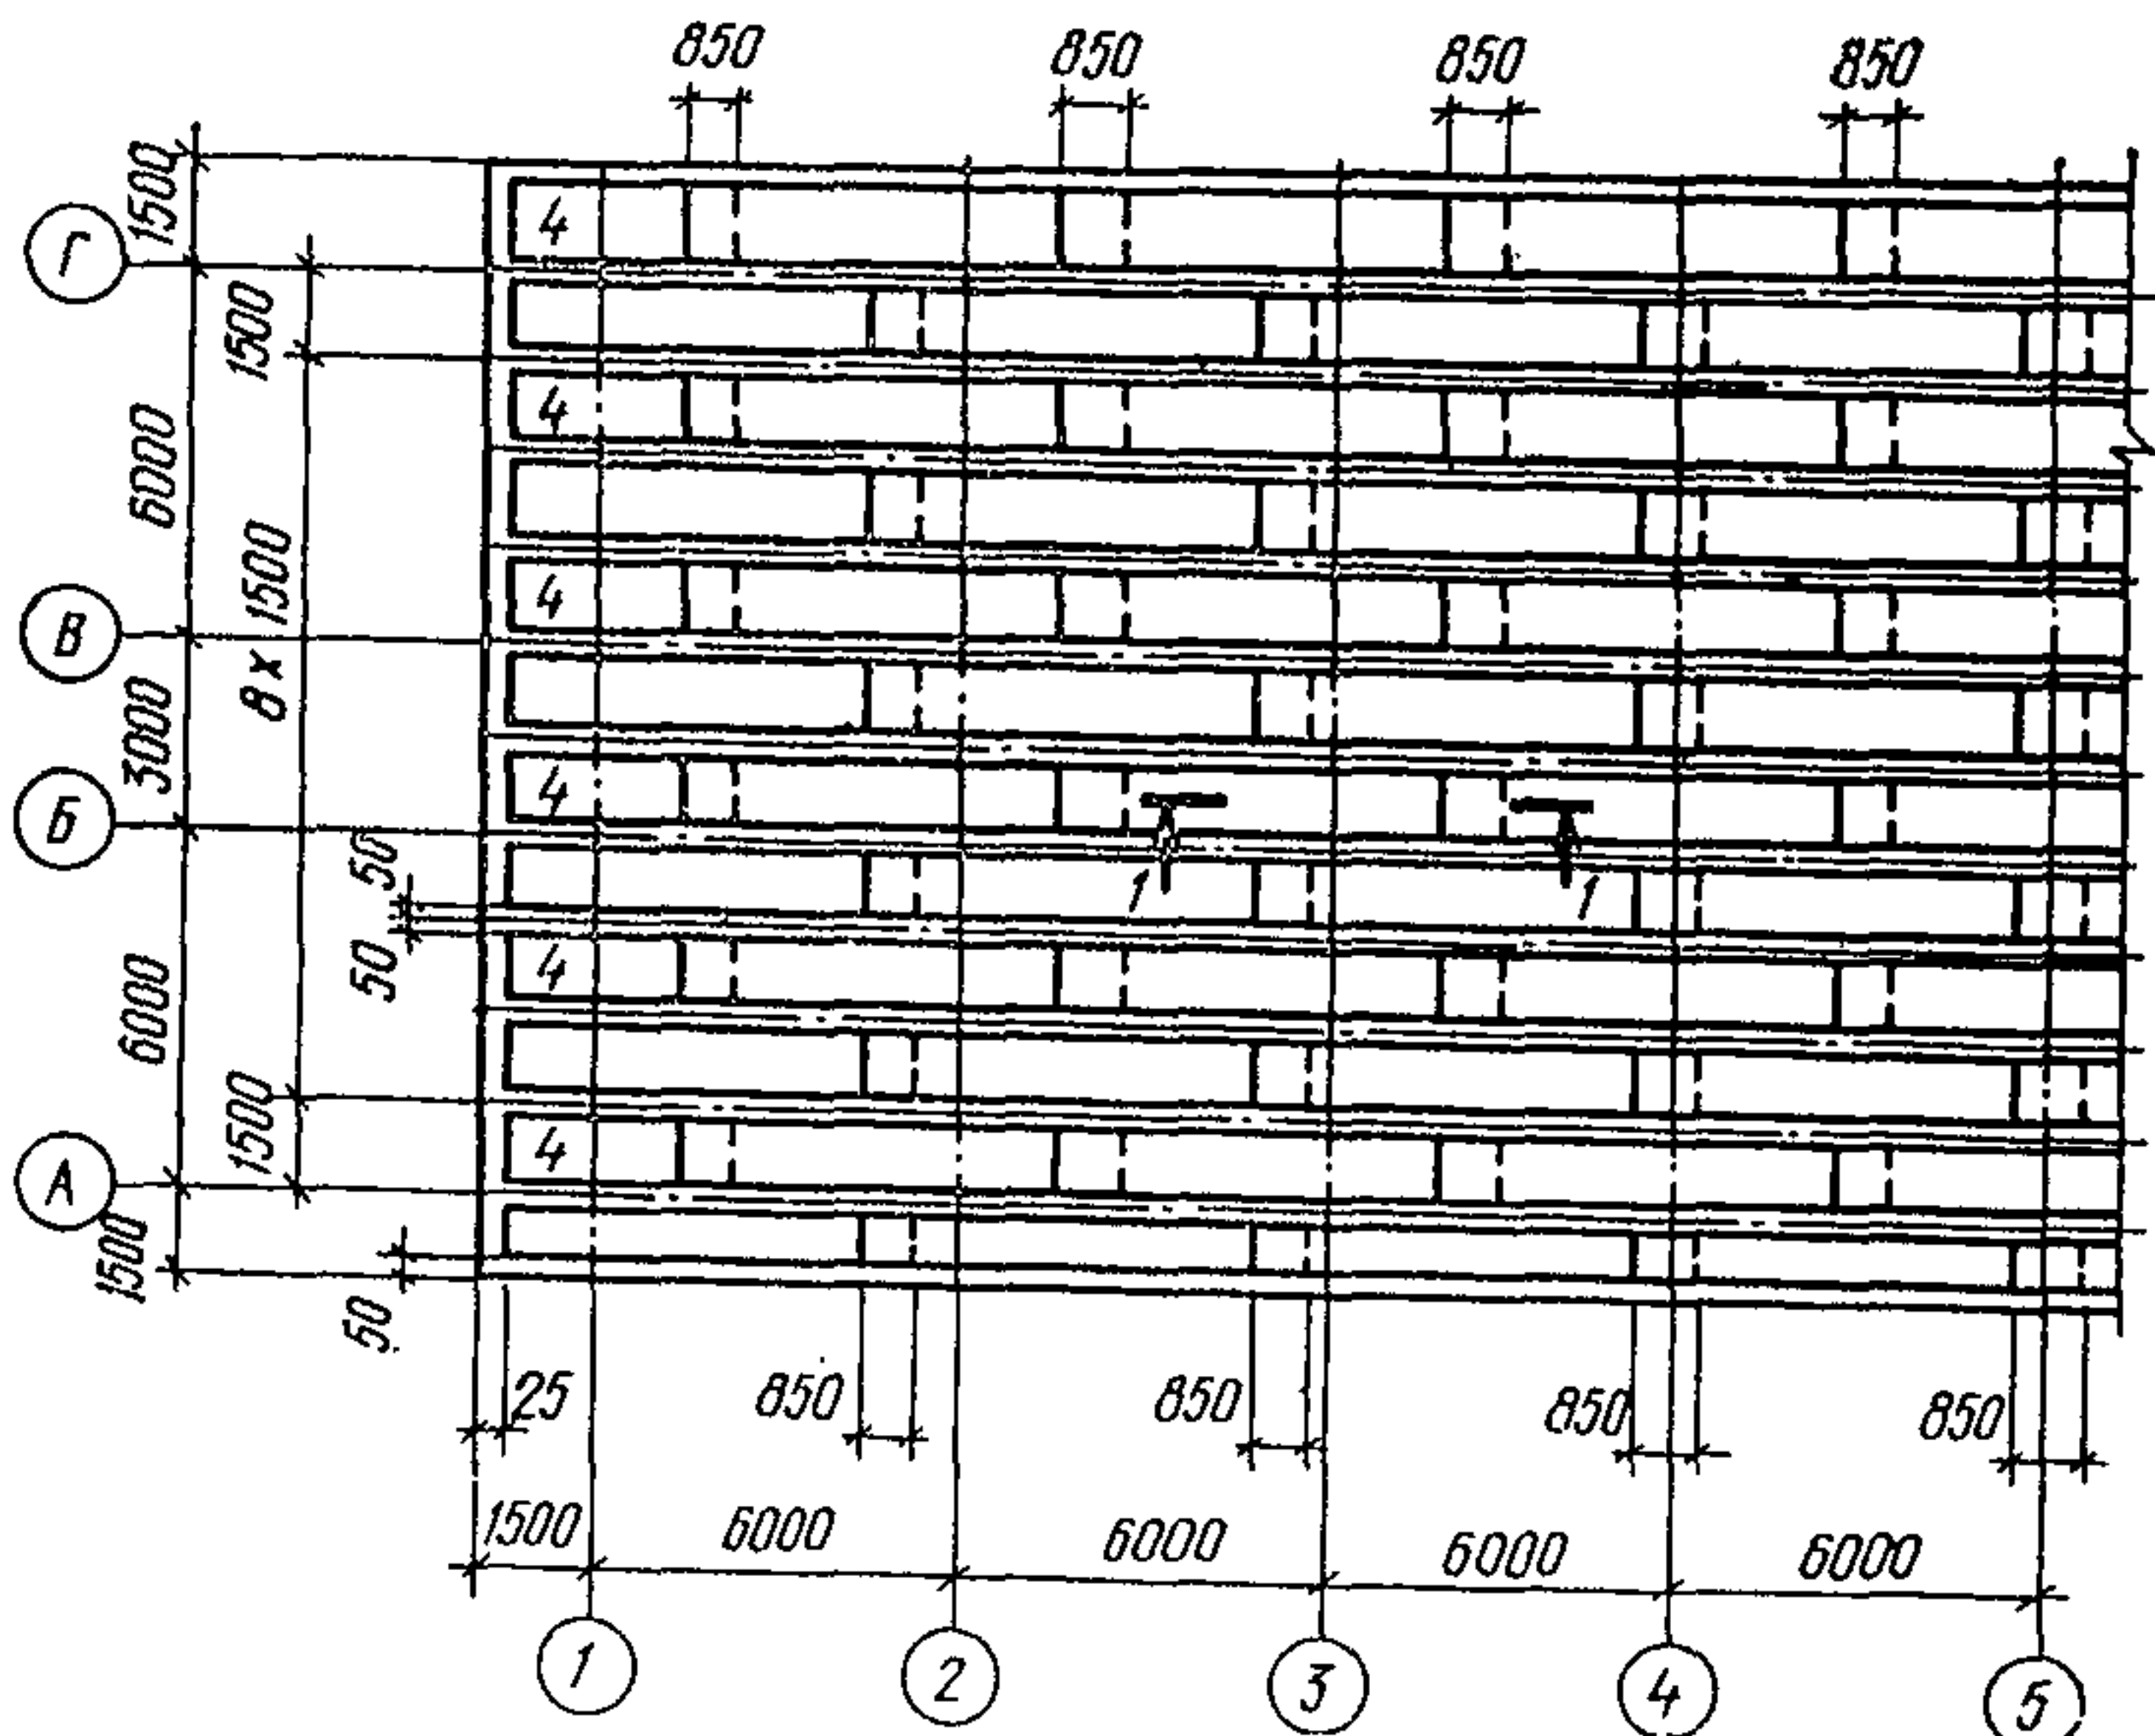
План раскладки унифицированных сеток второго слоя нижней зоны (нижние сетки) и первого слоя верхней зоны
